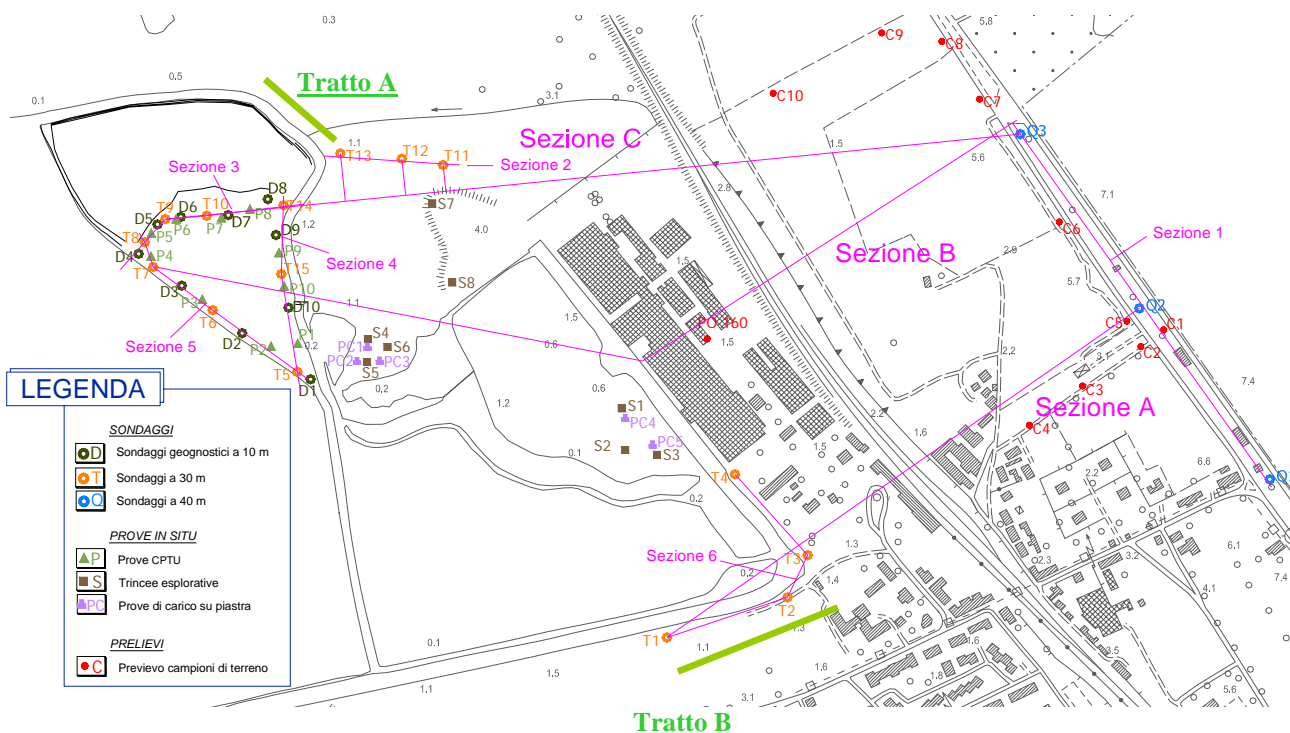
planimetria generale con indicazione del “tratto NORD (A)” e del “tratto SUD (B)” in progetto
